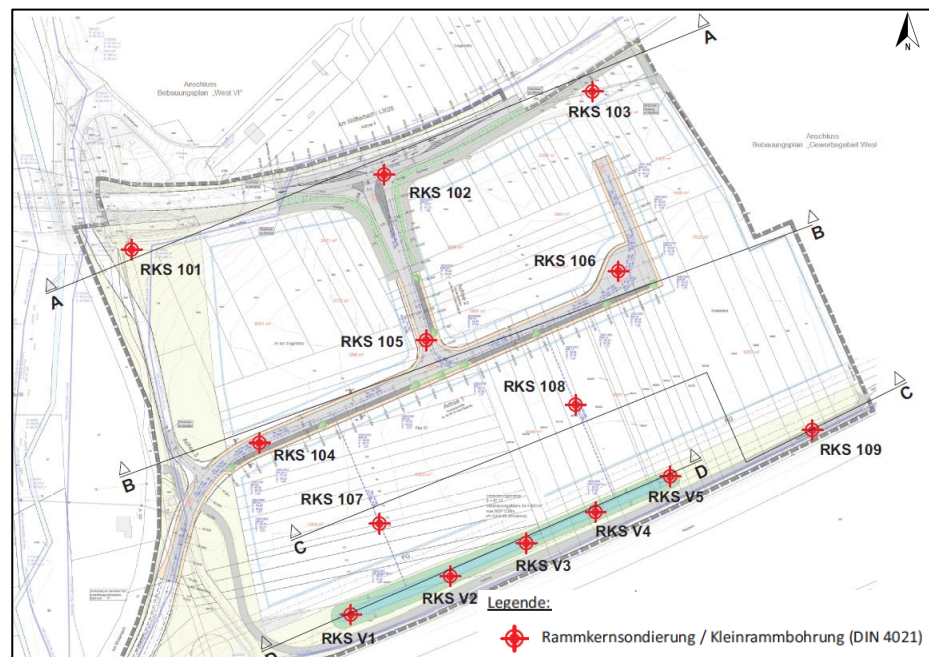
Lageplan mit Bohransatzpunkten (unmaßstäblich; ITC Ingenieure, März 2023)
